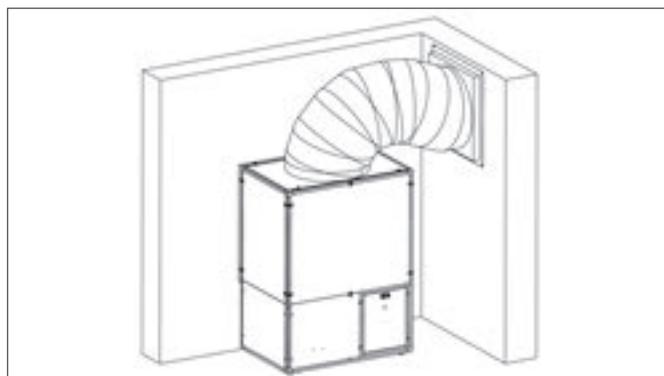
Installazione con tubo flessibile – Variante 2
